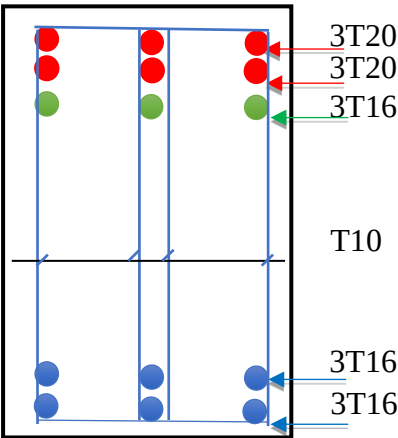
Ferrailage de la poutre de libage (sens longitudinal)
